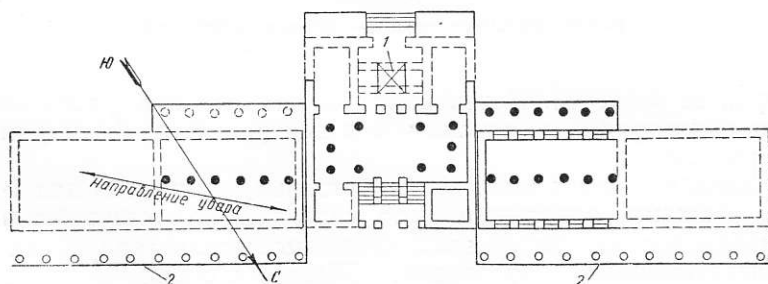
Схема плана железнодорожного вокзала (пунктиром показаны разрушенные стены и колонны)
